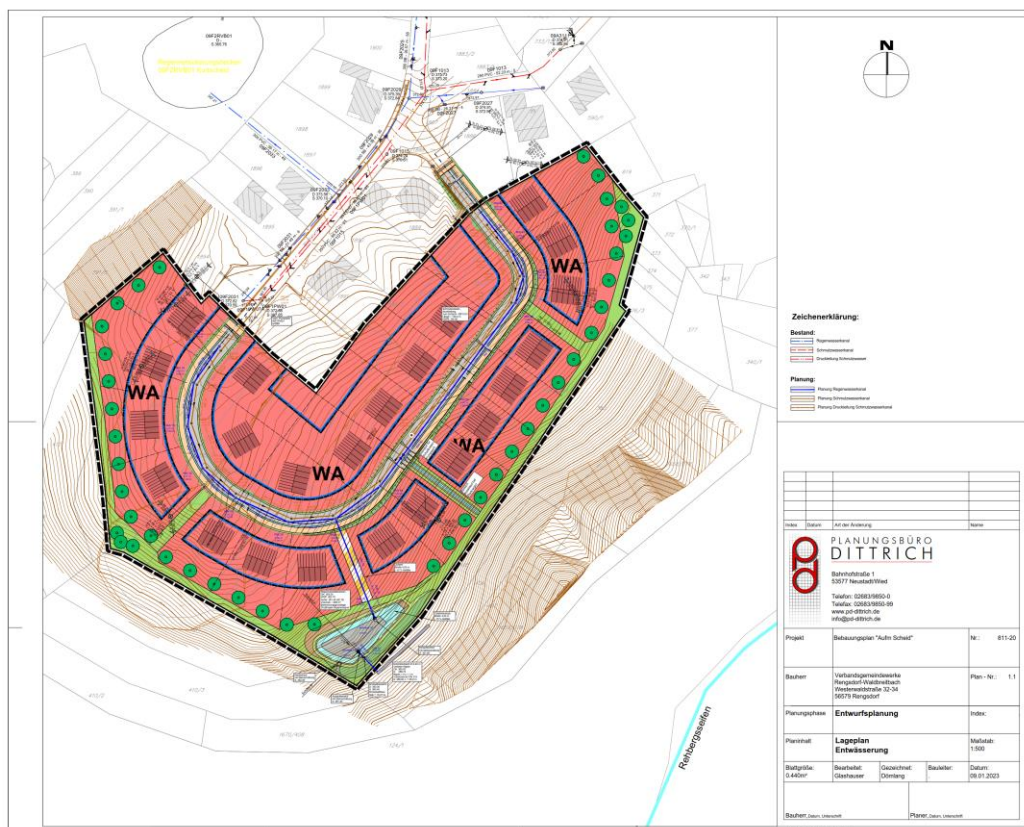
Lageplan aus der Fachplanung vom 28.02.2023
